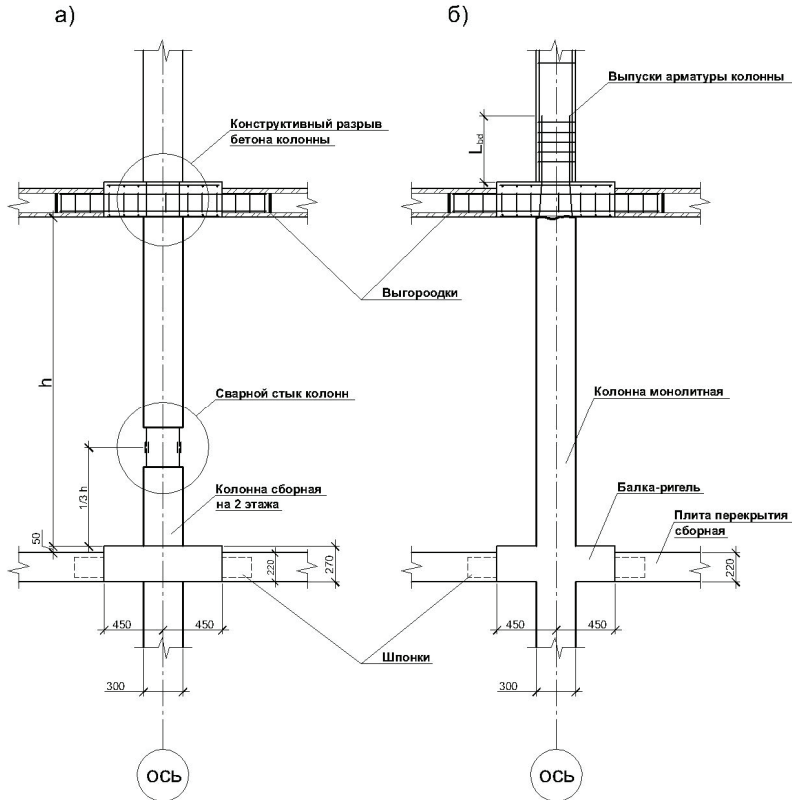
Сборная и монолитная колонны среднего ряда в рамном железобетонном каркасе со сборно-монолитными железобетонными перекрытиями: а) сборная колонна; б) монолитная колонна.
